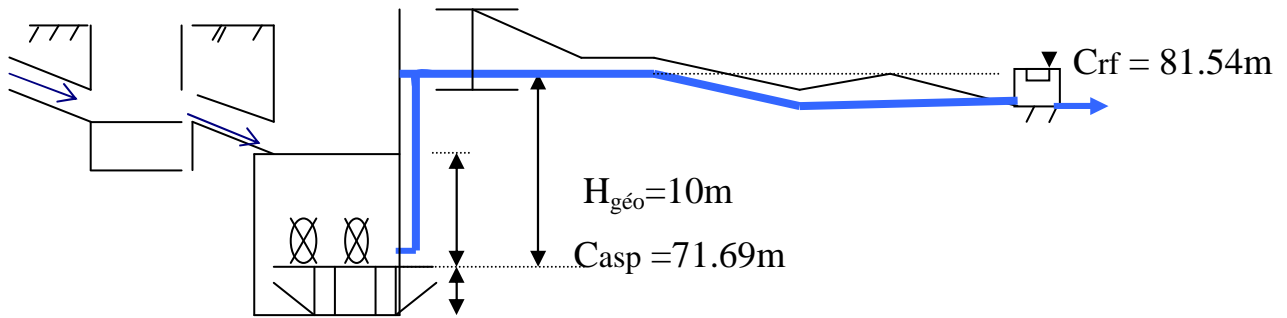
Plan déterminer la hauteur géométrique $H_{géo}$
